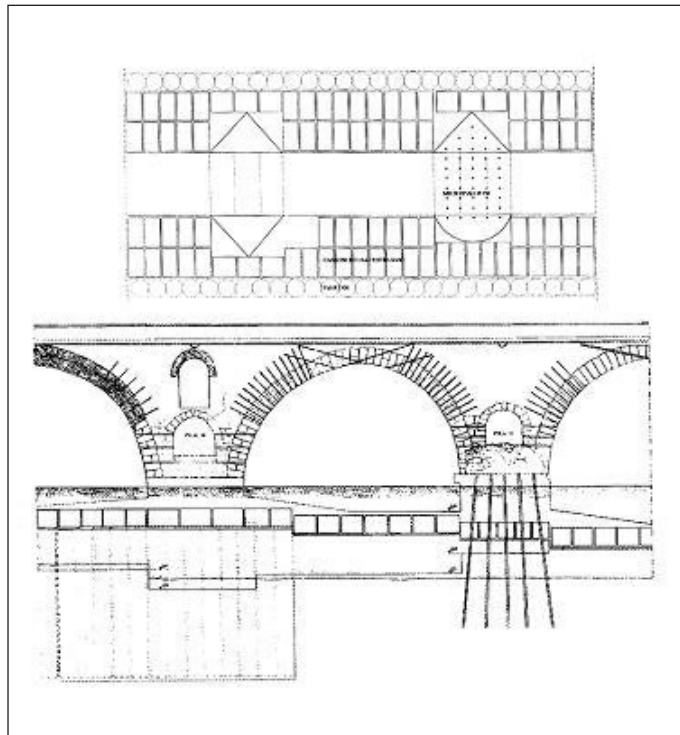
Ponte Milvio, proposta di sottofondazione di micropali.
